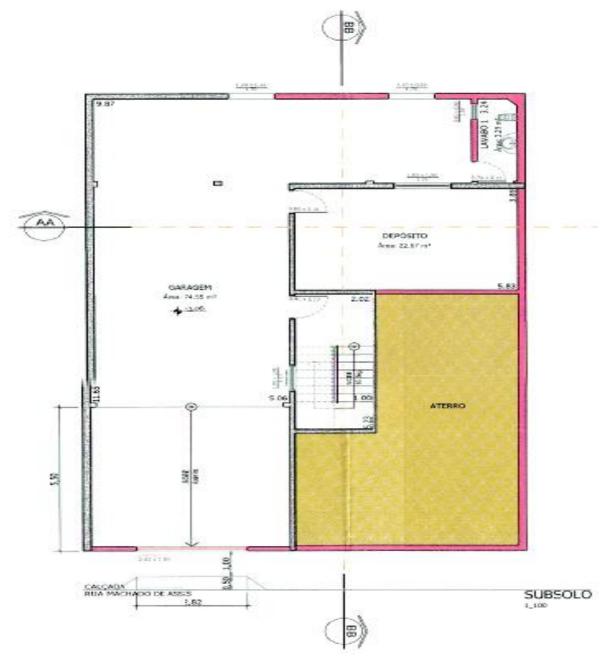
Planta Baixa do Subsolo Estudo de Caso 3
